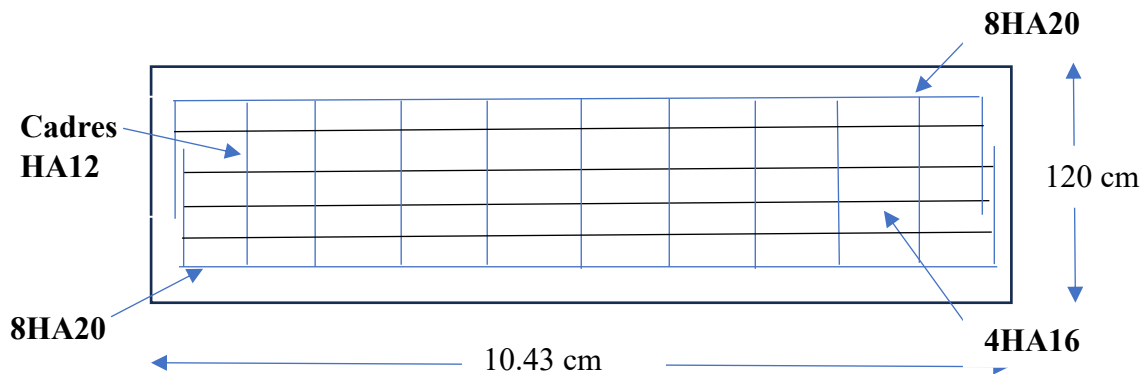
Schéma du ferrailage longitudinal du chevêtre.
